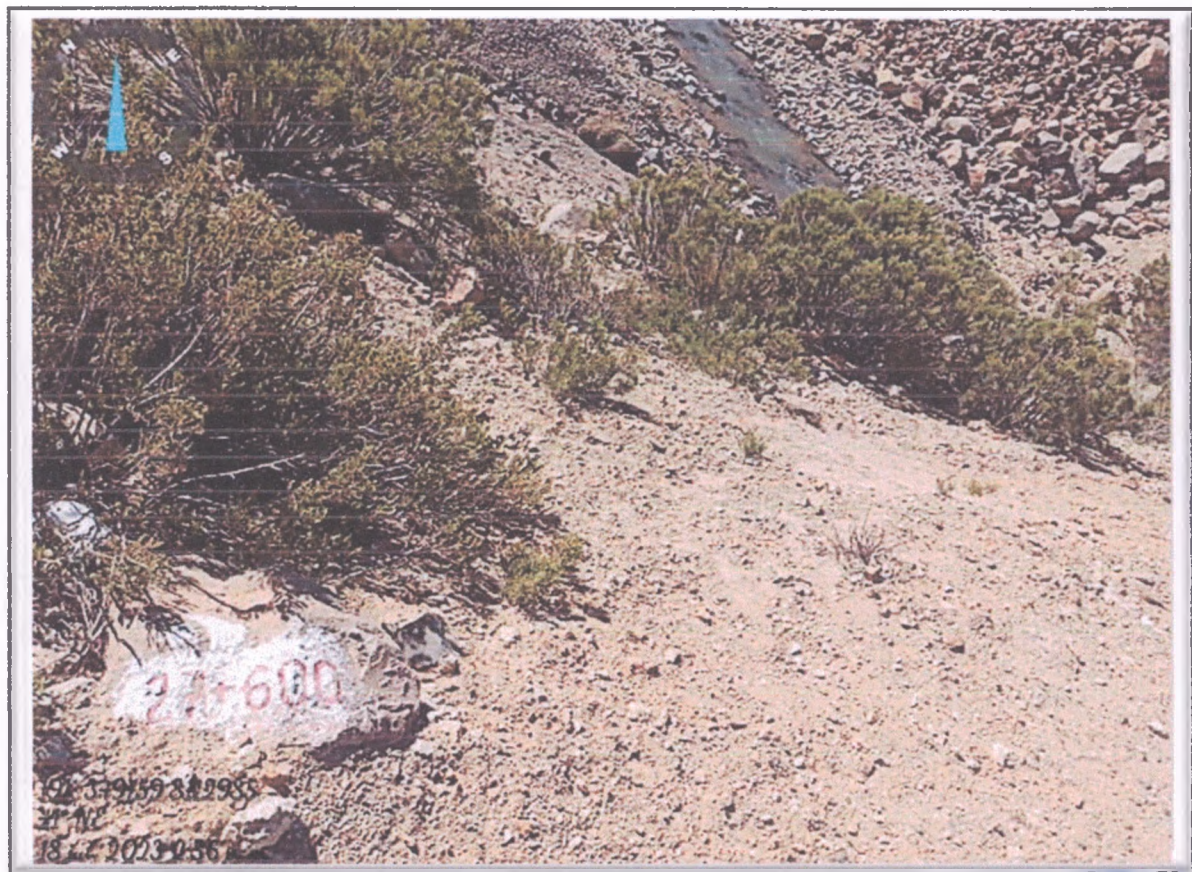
Replanteo y pintado de Kilometrajes.
